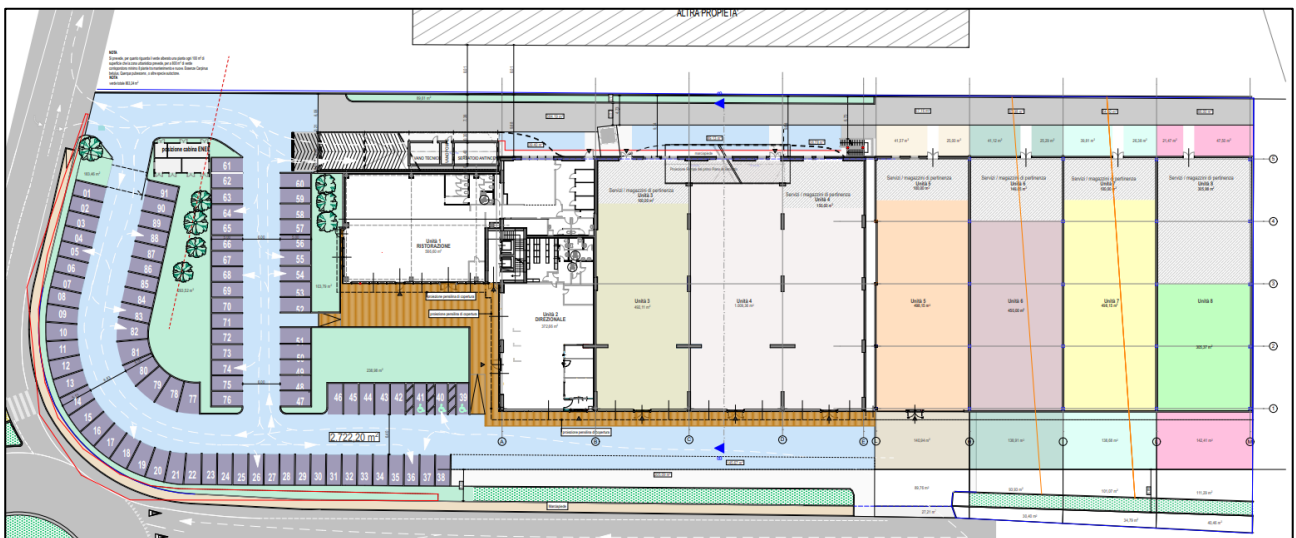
Planimetria di progetto del piano terra del fabbricato.
